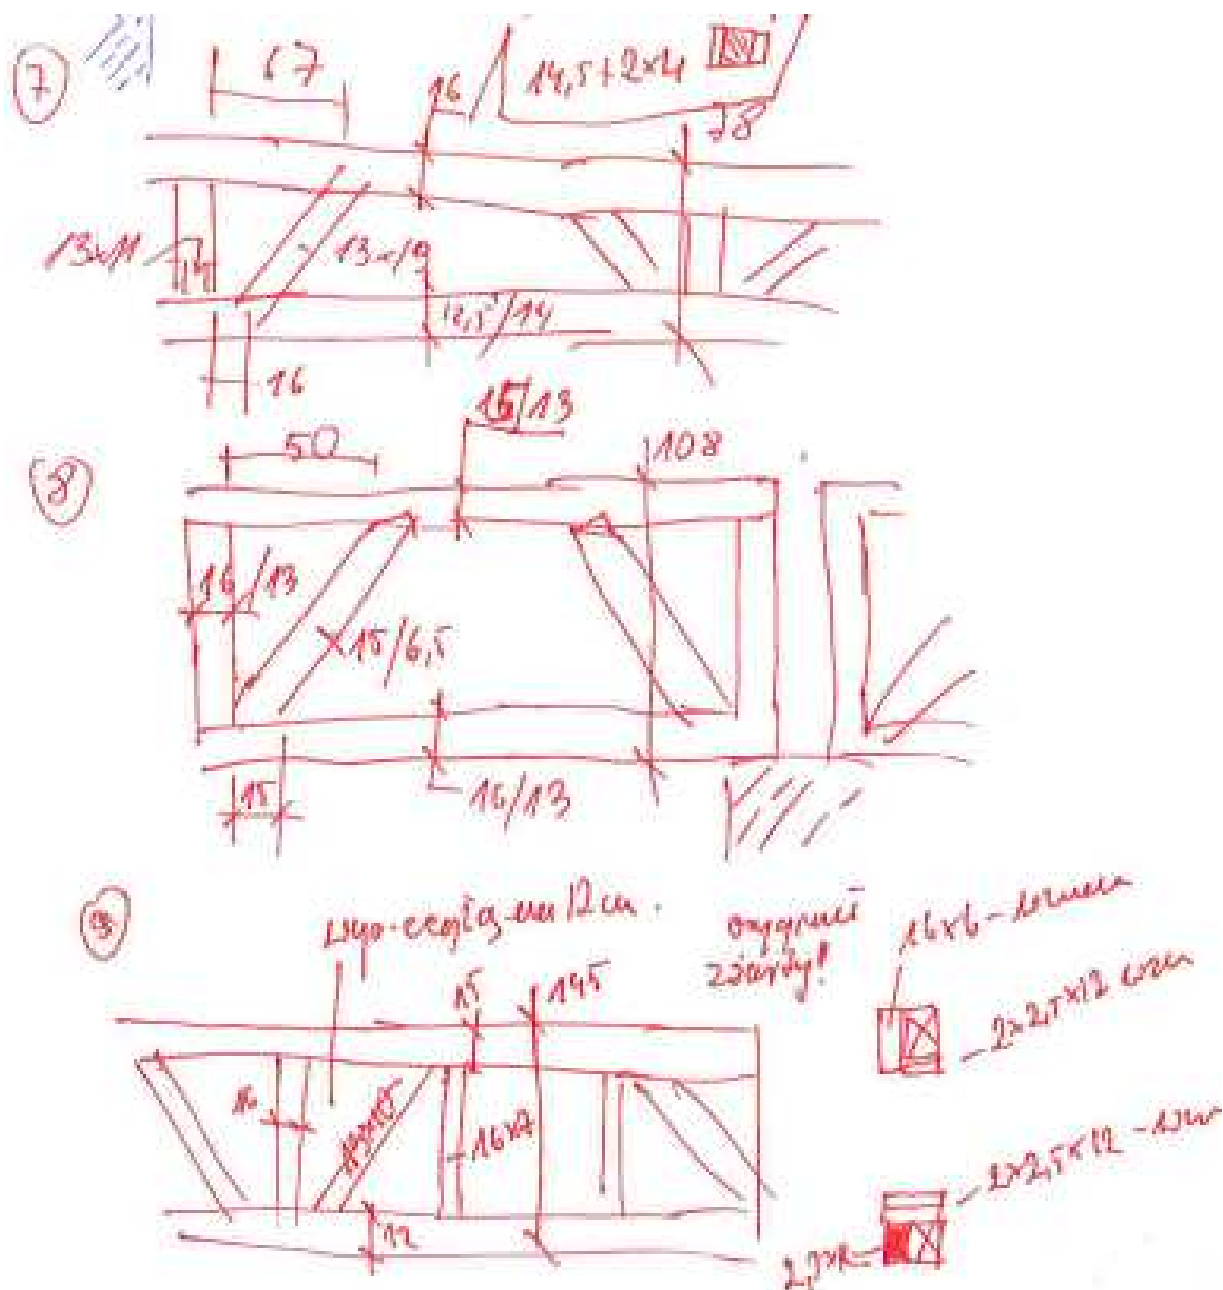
Przekrój przez drewnianą konstrukcję dachu nad „Salą na Piętrze”
